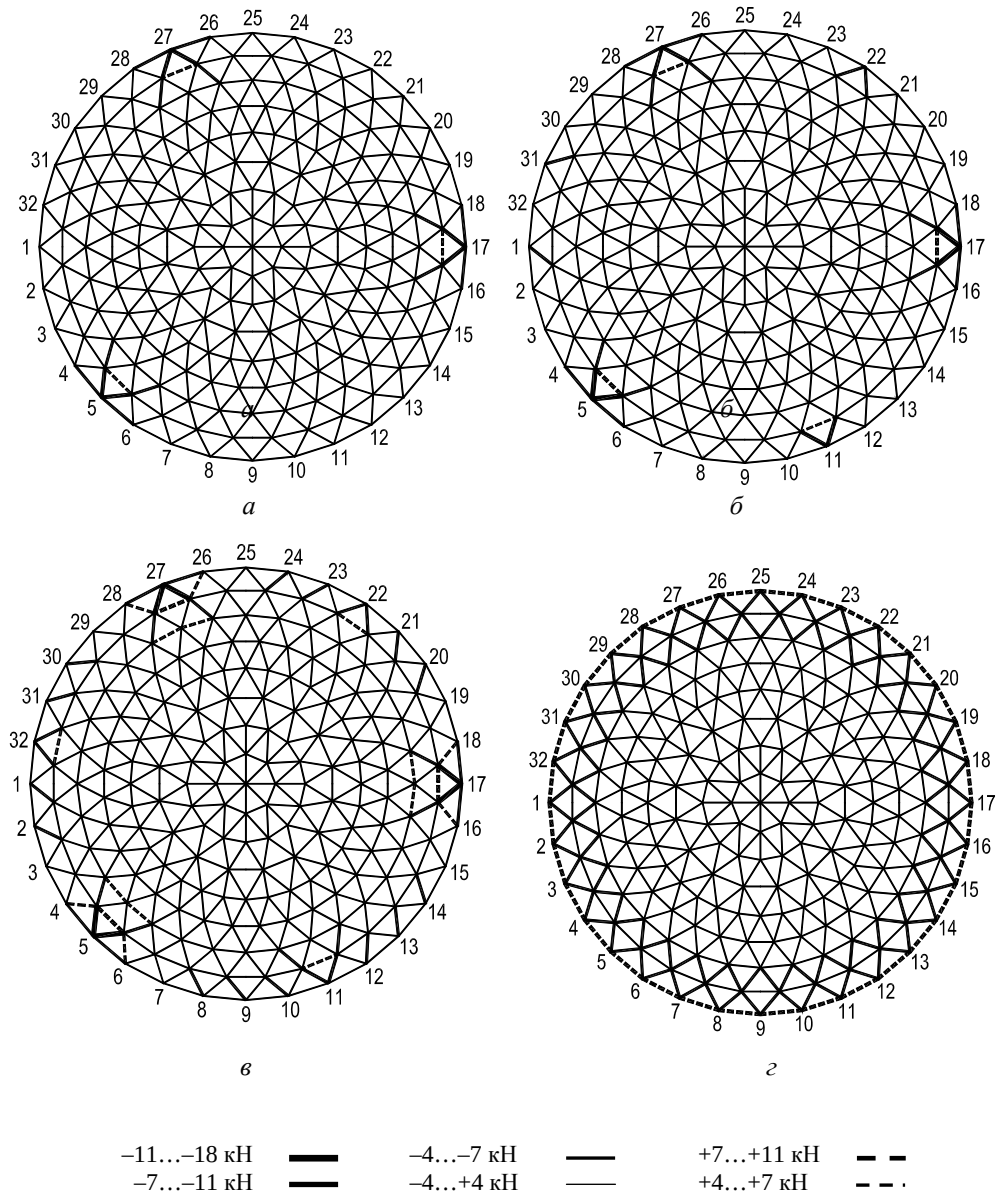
Схемы распределения начальных усилий в стержнях купола от собственного веса каркаса: а — 1-й этап деформирования для схемы г начального опирания; б — 2-й этап деформирования; в — завершение деформирования; г — при проектном опирании на все контурные узлы
